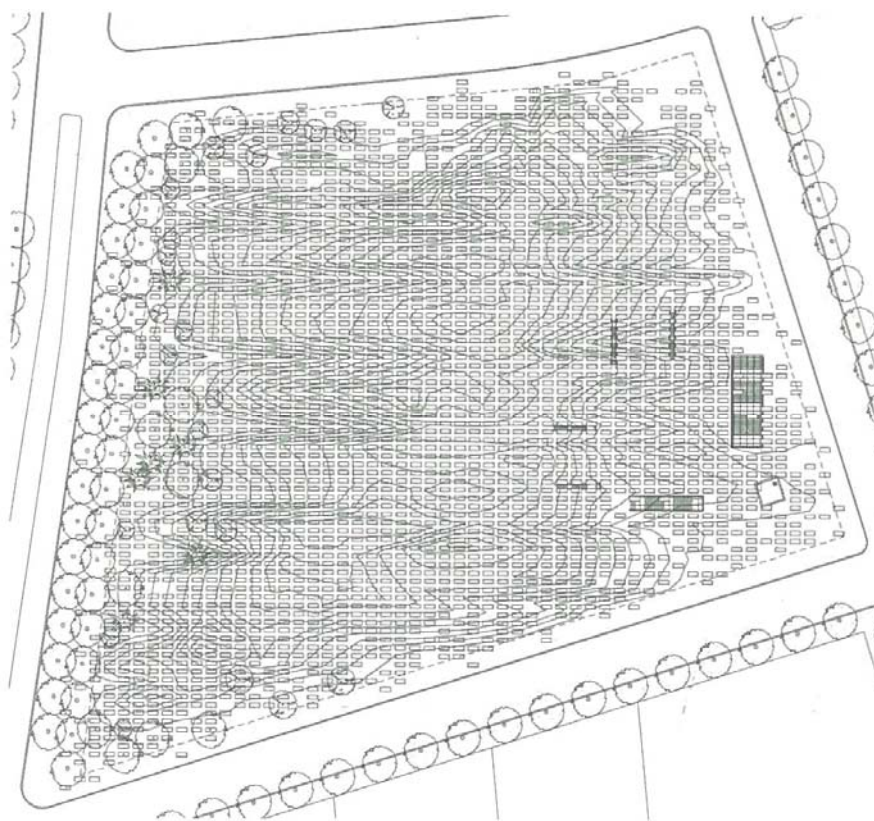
Planta geral (Eisenman, 2007 p. 50)
